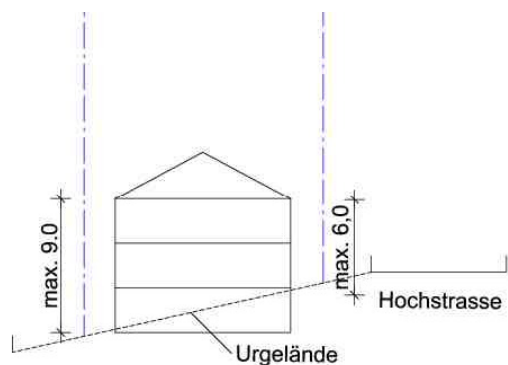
Schemaschnitt mit Festsetzung der Wandhöhen
